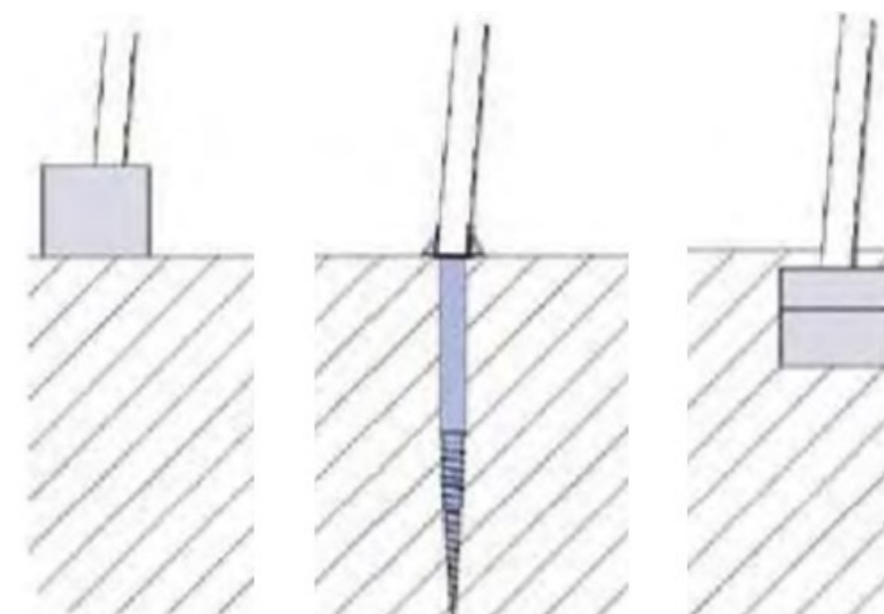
Trois types de fondations : plots en béton posé à gauche, pieux (vissés ou battus) au centre et plots enterrés à droite (source : Exosun)
